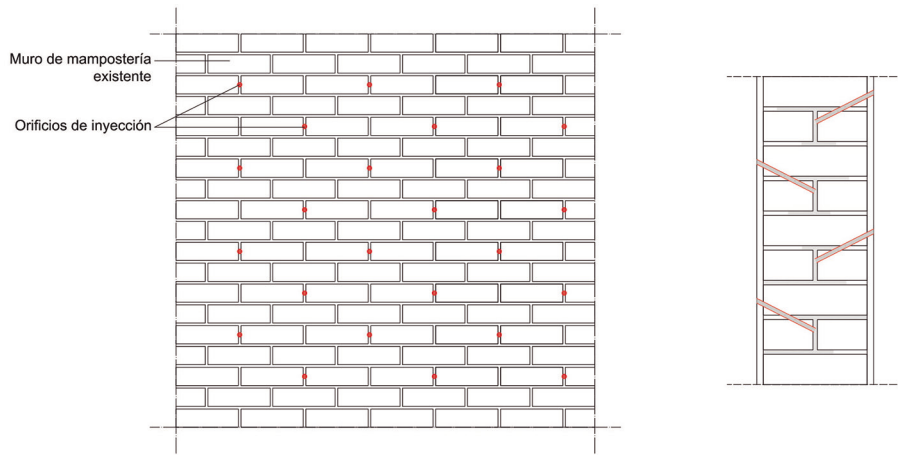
Inyección de lechada o resina epoxi. Esquema y detalle constructivo.
